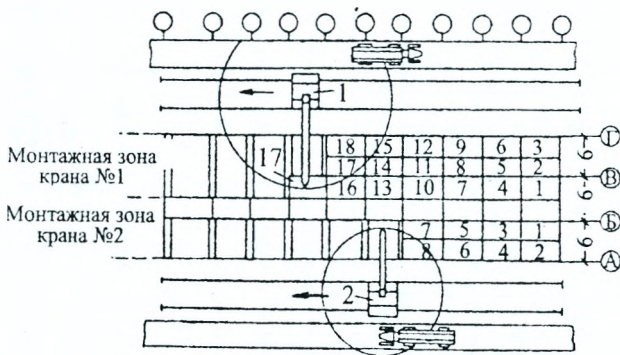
Схема монтажа конструкции каркаса с расположением башенного крана с двух сторон здания
